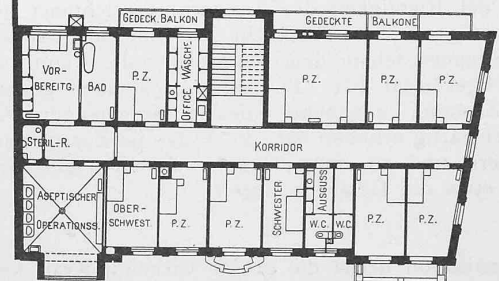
bis 6. Grundrisse vom Keller- und Erdgeschoss, sowie vom ersten Stock und Dachgeschoss.
